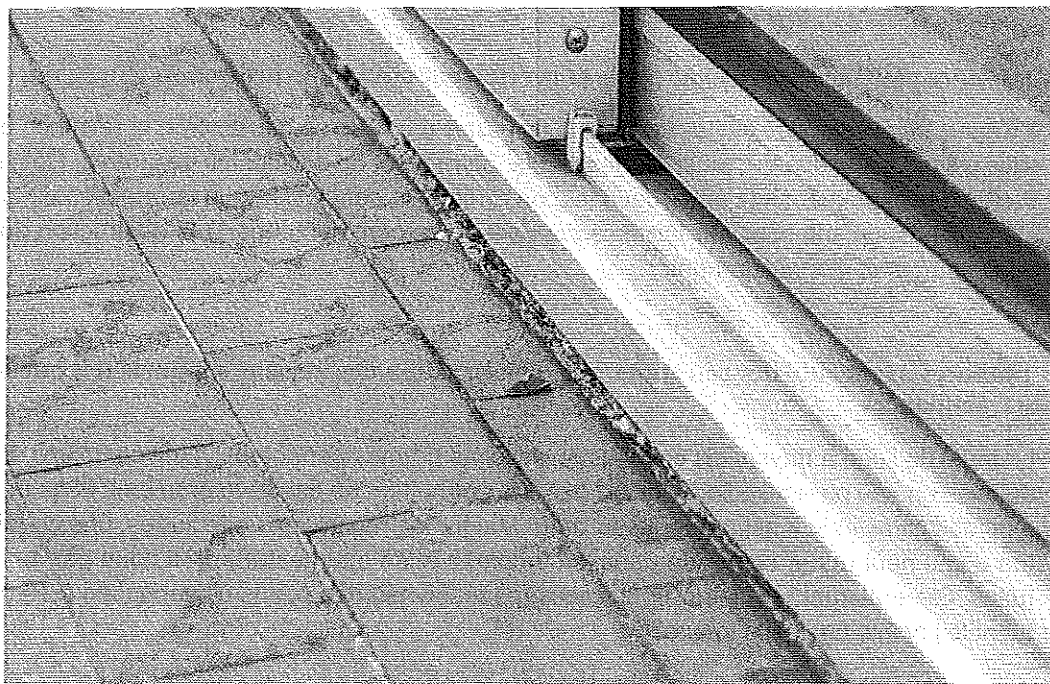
Jonction bâti-carrelage défailante, mauvais calfeutrement. © J. Putatti
